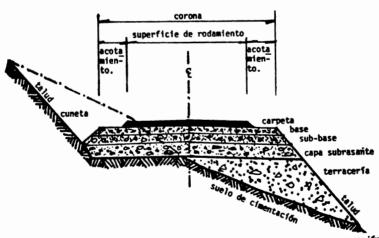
Sección transversal típica de un pavimento flexible, en una sección de terraplin.
